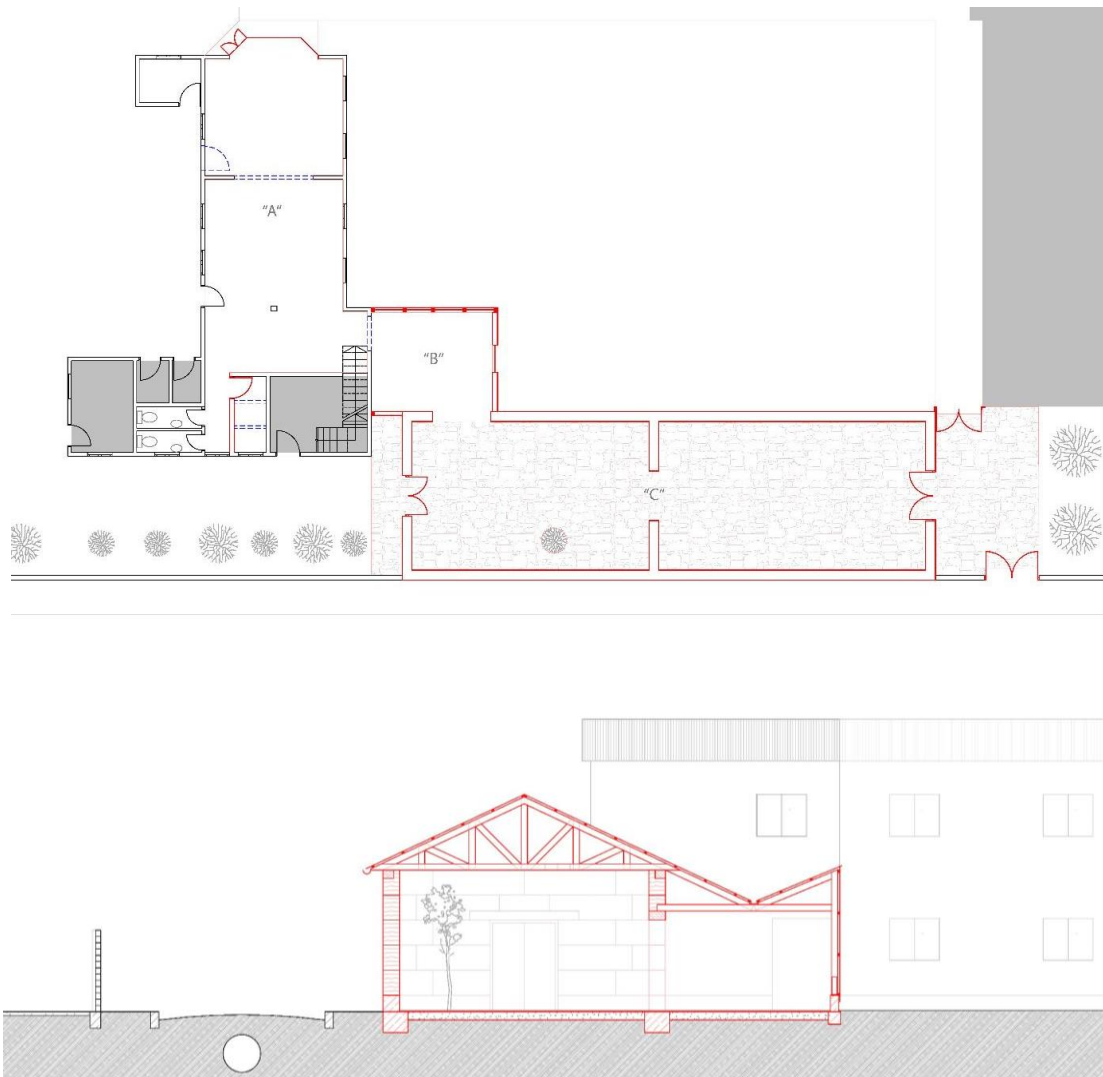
Planta y corte transversal del Museo Vivo Interactivo Yatiyawi
